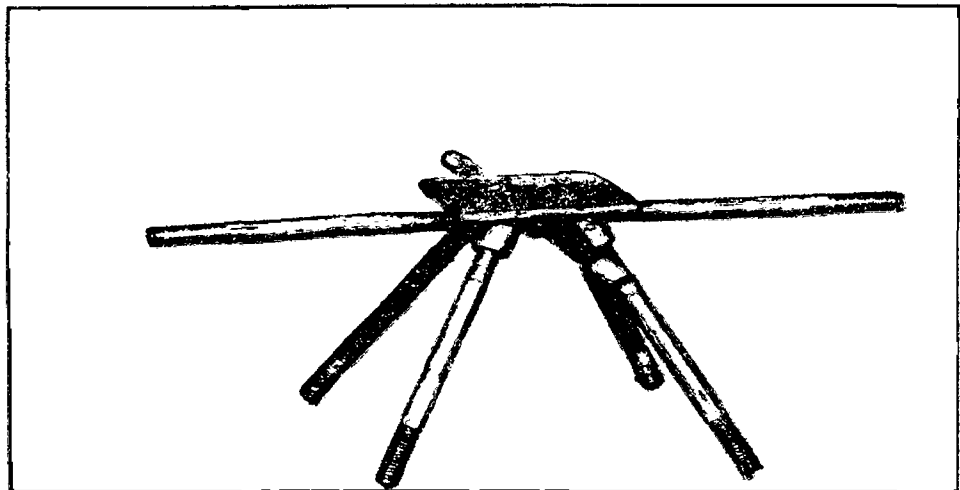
Modelo típico de nudo para ensamblar estructuras especiales con elementos tubulares metálico y en madera, en el modelo del nudo se muestra 4 barras diagonales y 4 elementos horizontales.
